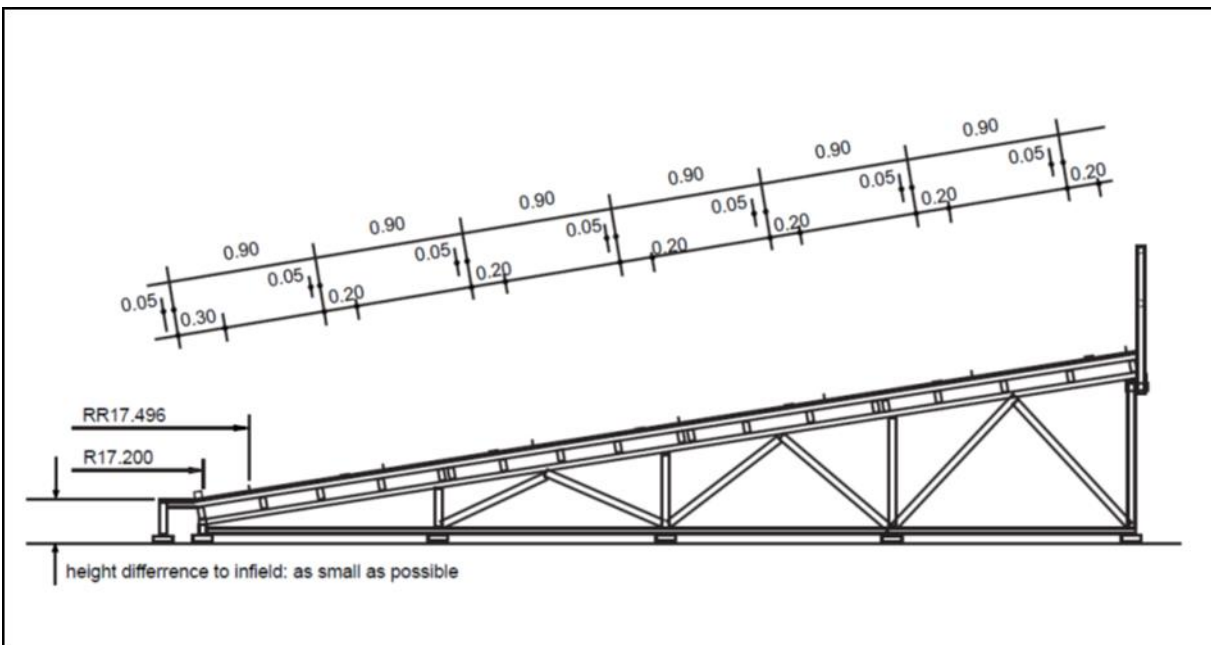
Section transversale des virages inclinés standard (dimensions en m)
